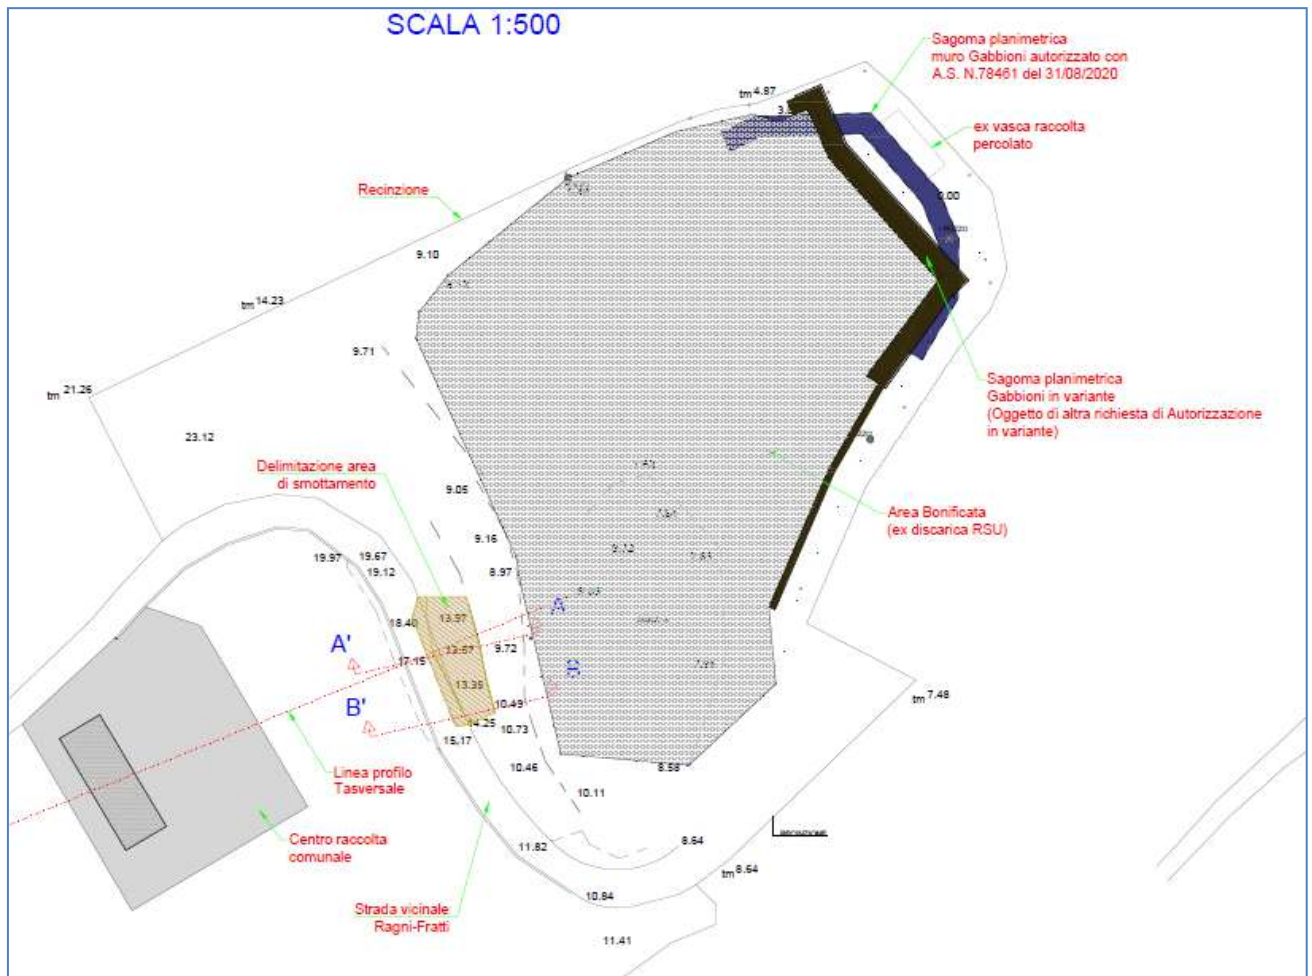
Planimetria generale dell'area, con sviluppo dei muri in progetto
